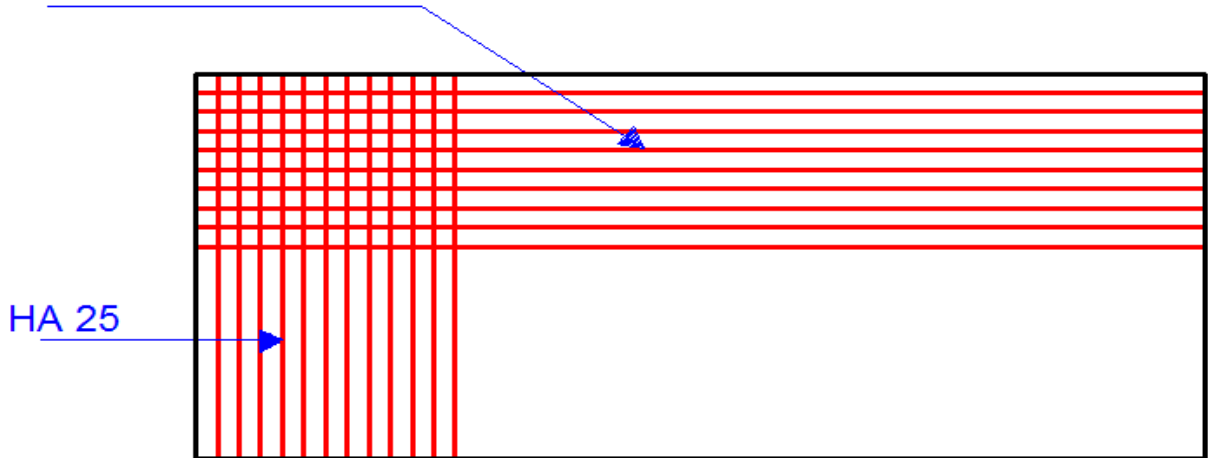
Schéma de ferrailage (nappe inférieure)
